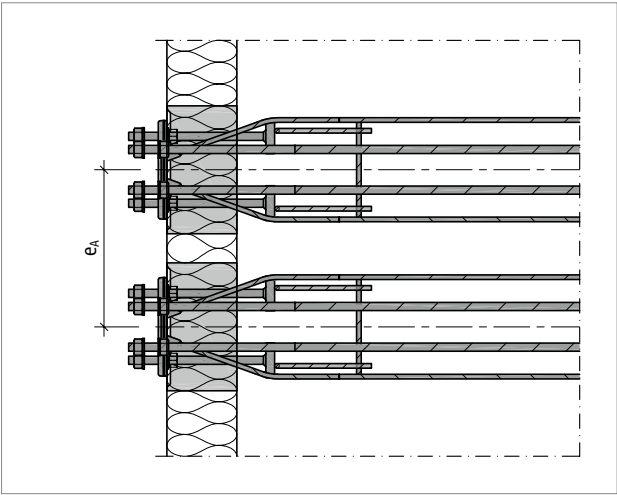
Schöck Isokorb® XT Typ SK: Achsabstand
